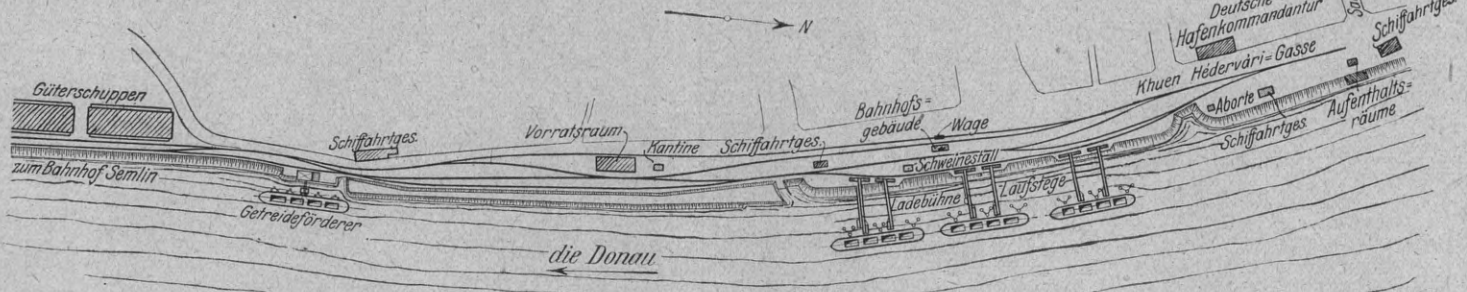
Lageplan der Getreideförderanlage in Semlin. Maßstab 1:6000.
